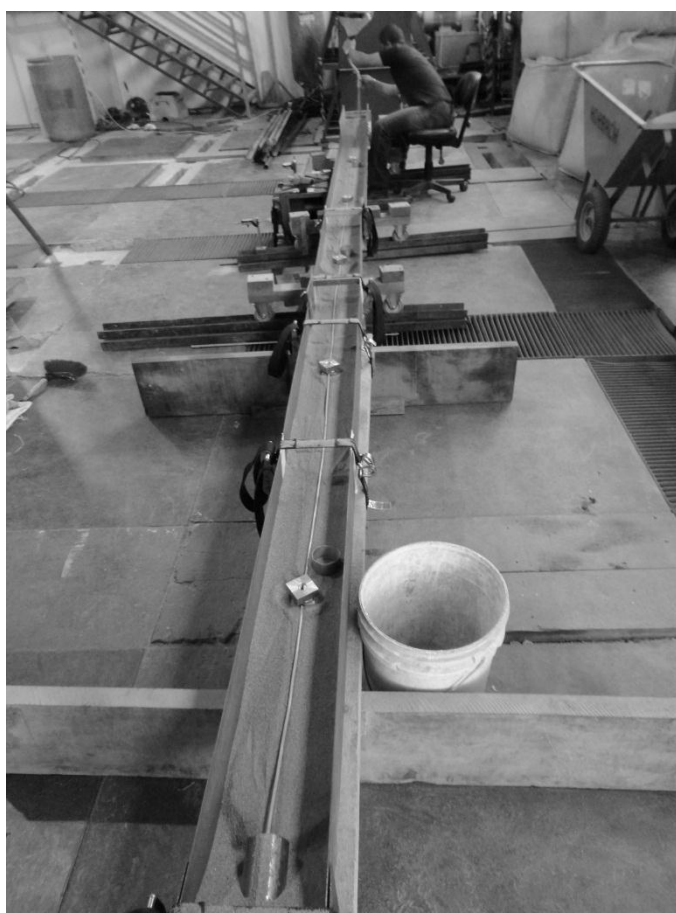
CONFIGURAÇÃO DO ENSAIO 2
